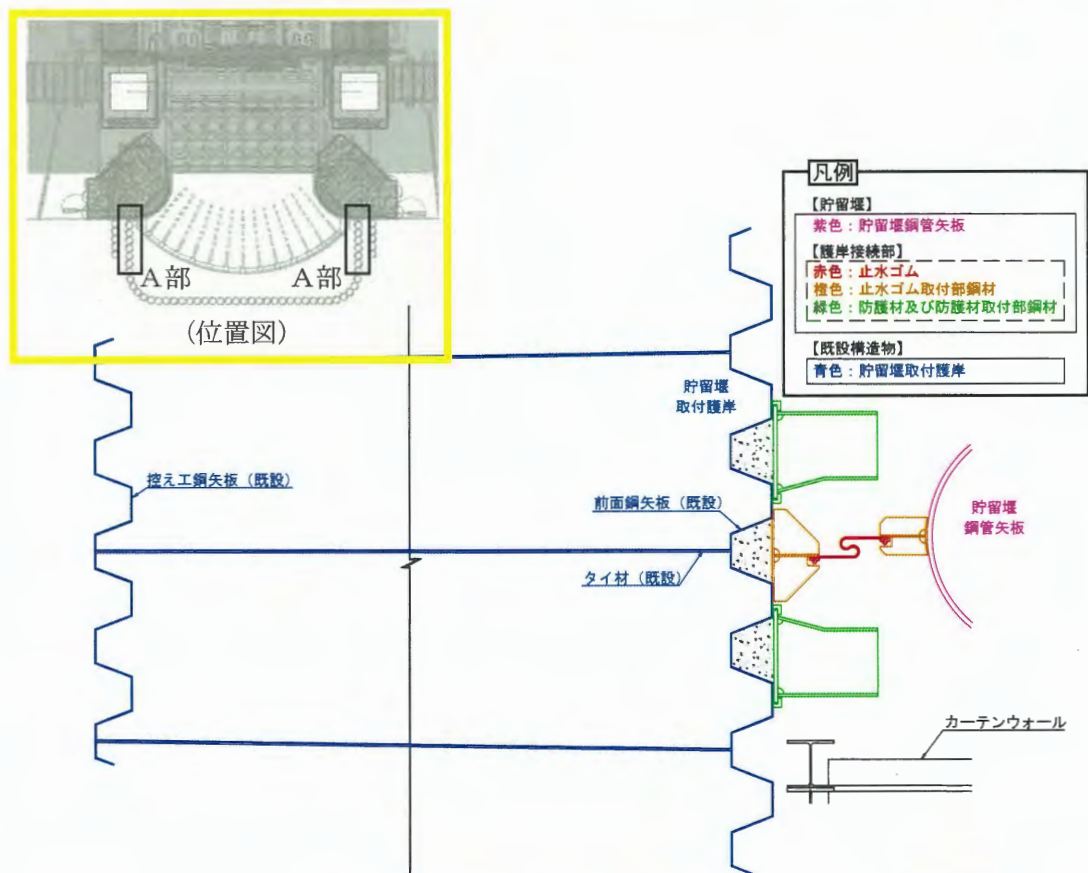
貯留堰及び貯留堰取付護岸の構造図 (平面図) A部
